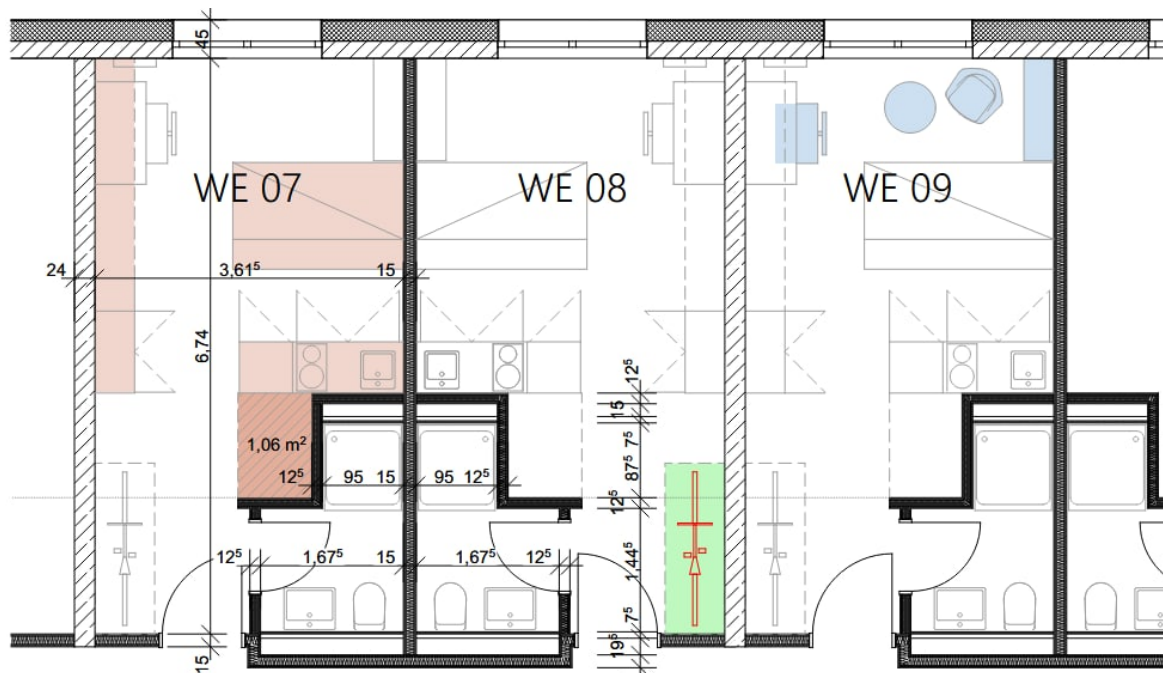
Regelgrundriss mit Fahrrad-Stellplatz
